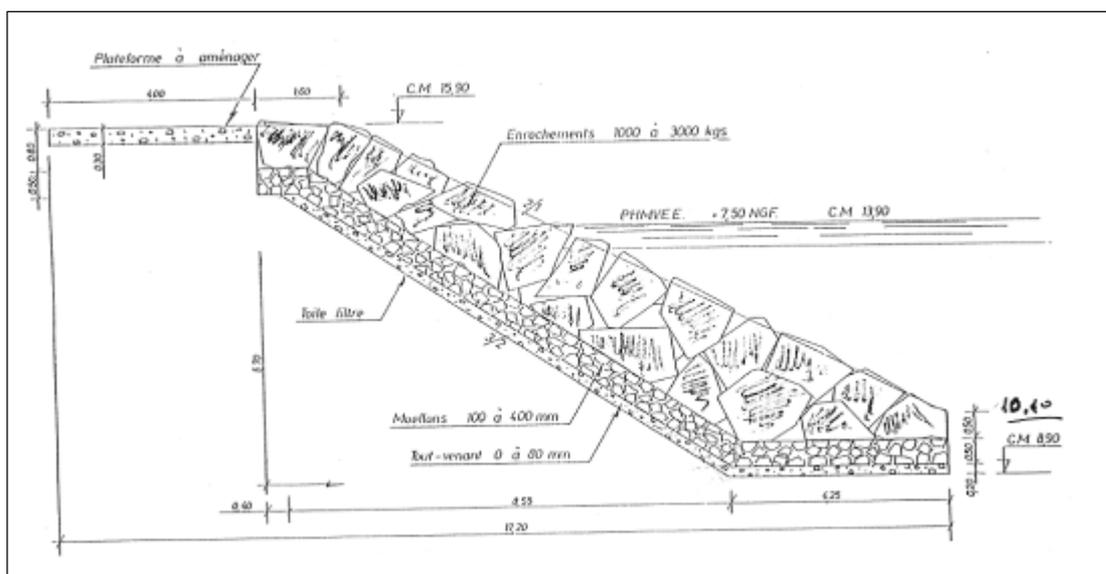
Profil en travers type de la digue de Montmartin-sur-Mer
